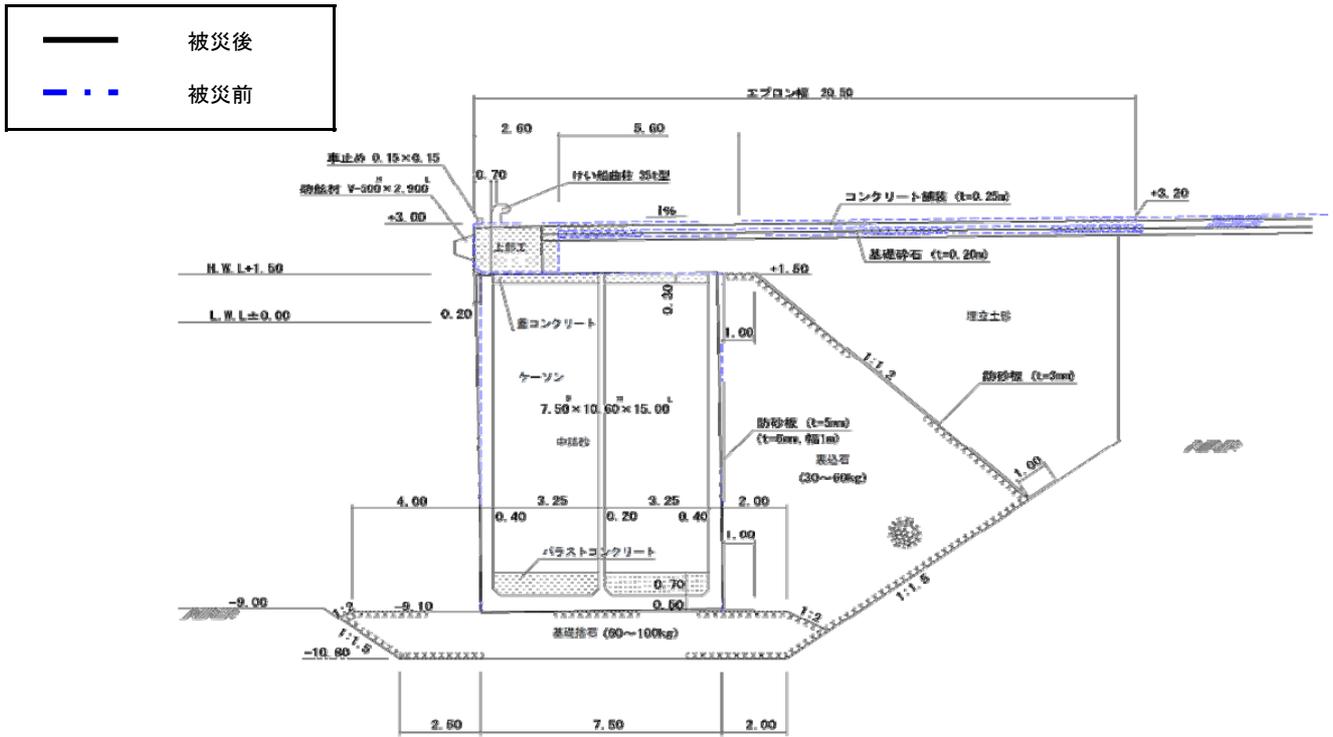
No.35 大洗港区_第4ふ頭地区岸壁 (-9.0m) 物揚場 (-4.0m) の断面図 (被災後)
